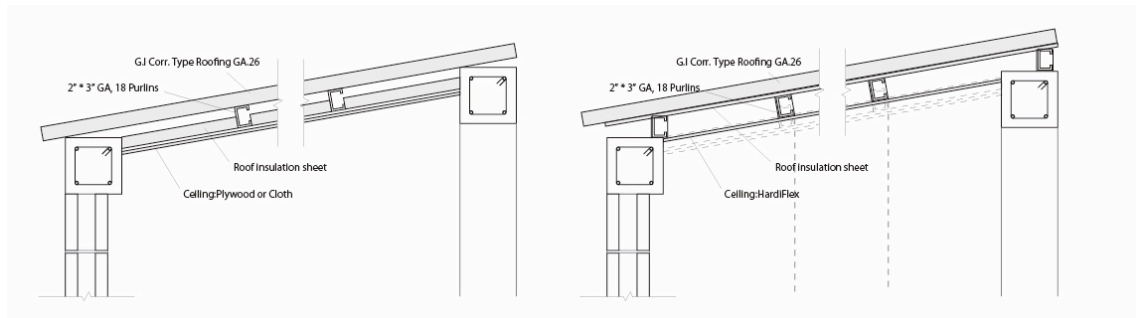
屋根・天井の設計案（左）と施工結果（右）
